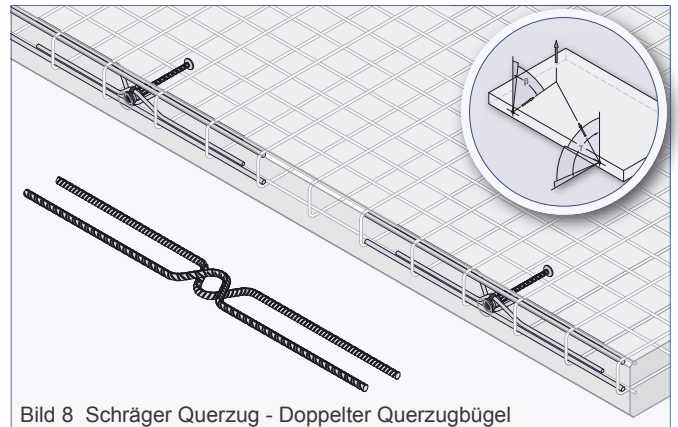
Schräger Querkzug - Doppelter Querkzugbügel
